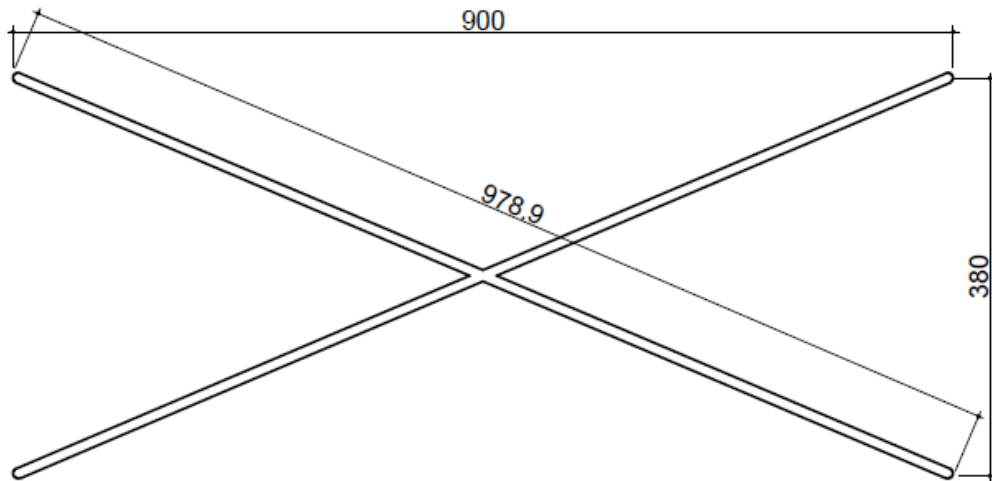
Planta de um módulo de pórtico bidirecional
